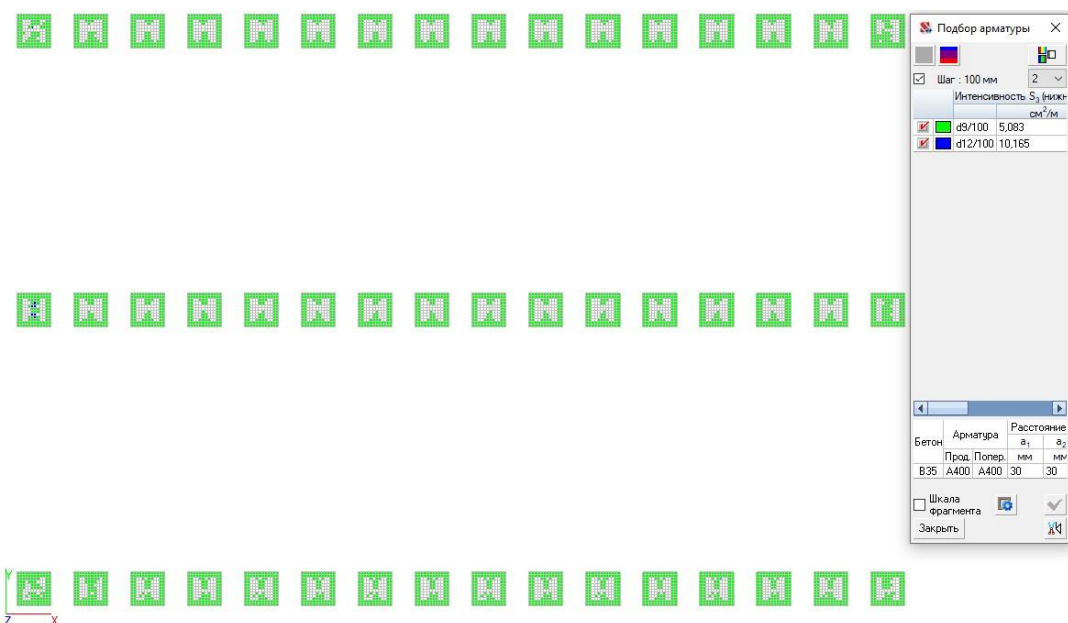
Интенсивность нижнего армирования фундаментов по ОУ
